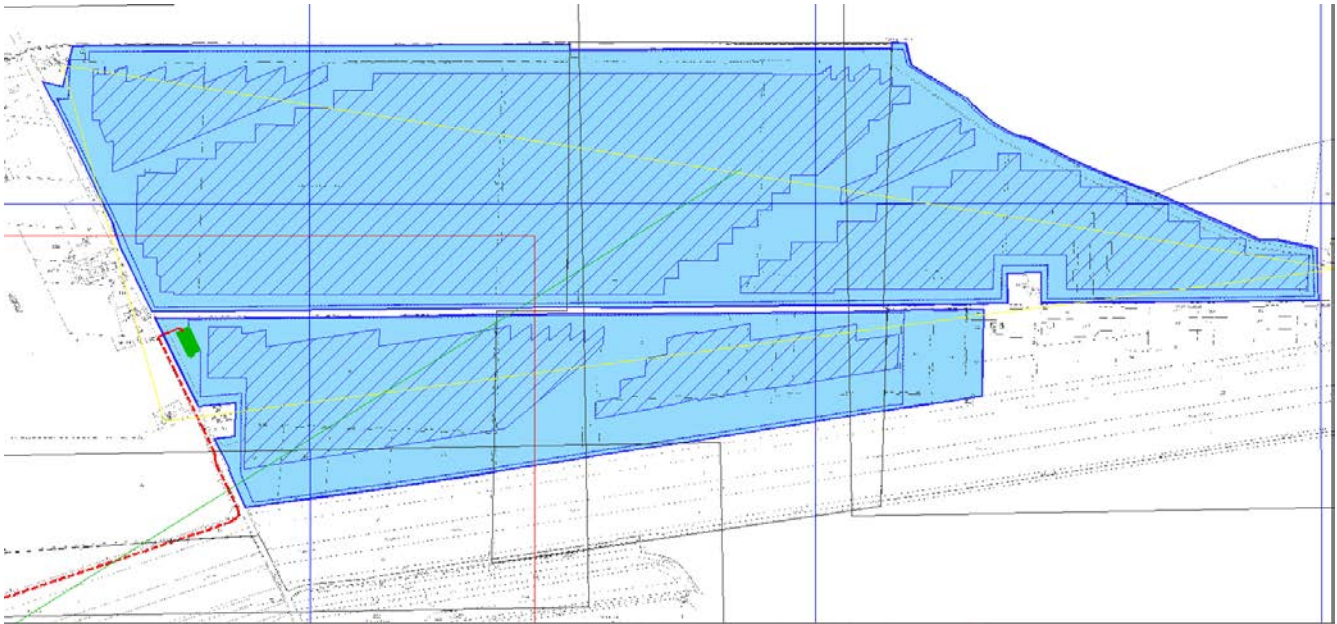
planimetria catastale con indicazione dell'area oggetto di intervento
